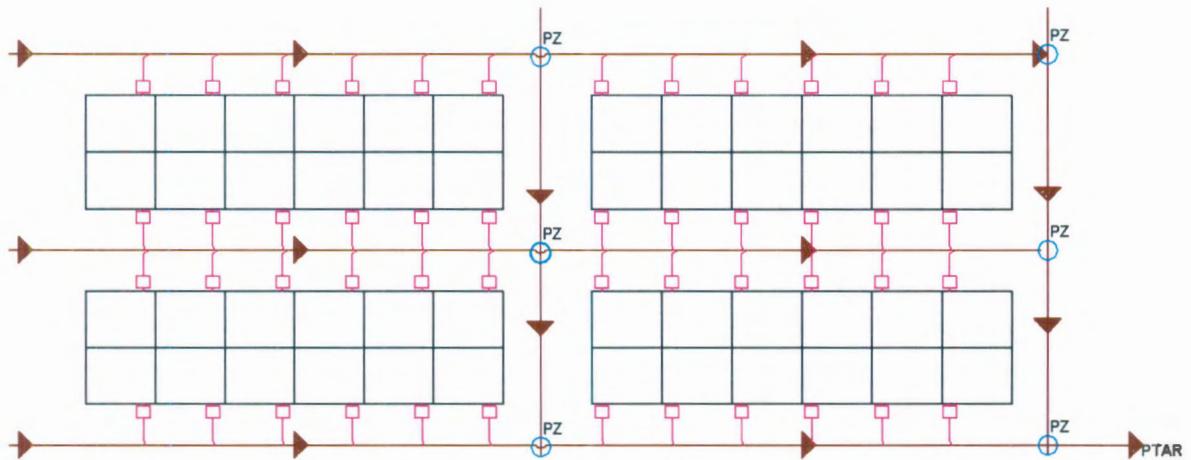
Esquema red de alcantarillado en espina de pescado
